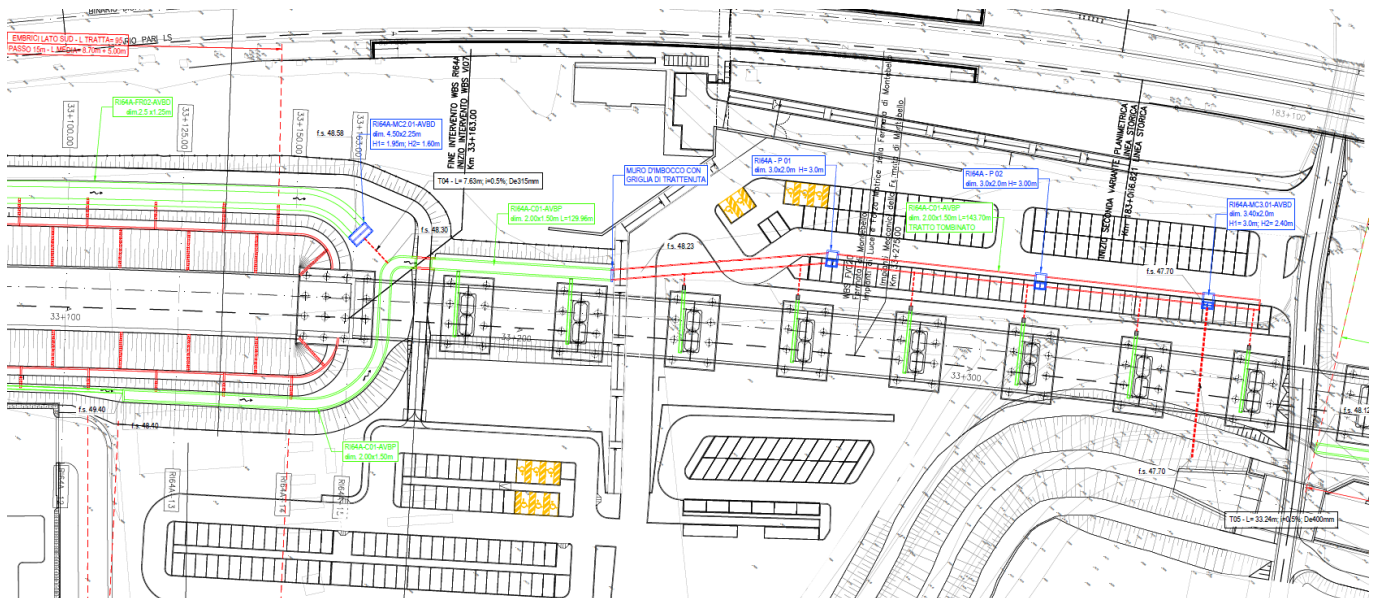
Stralcio planimetrico del fosso rettangolare a servizio del rilevato ferroviario e del viadotto tra le pile 1 e 7
